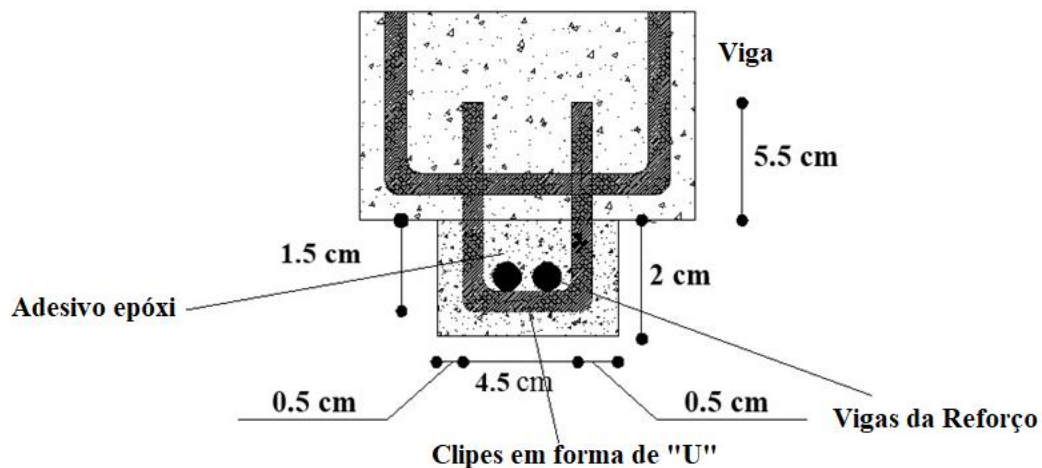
Detalhamento do grampo inserido nas vigas E3 e E5 para auxiliar na ancoragem entre o reforço e a peça.
